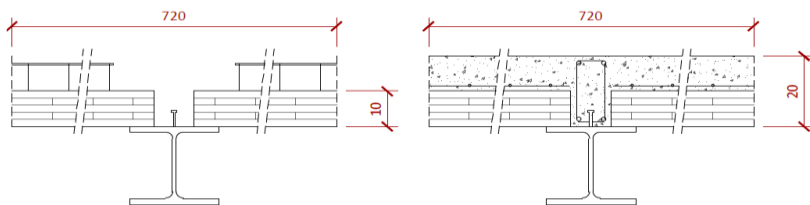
Sezione tecnologica della trave + solaio prima e dopo il getto collaborante in cls
